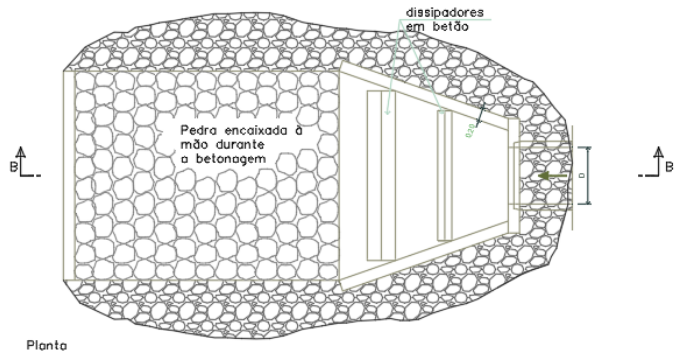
Planta de bacia tipo “Contra-Costa”
